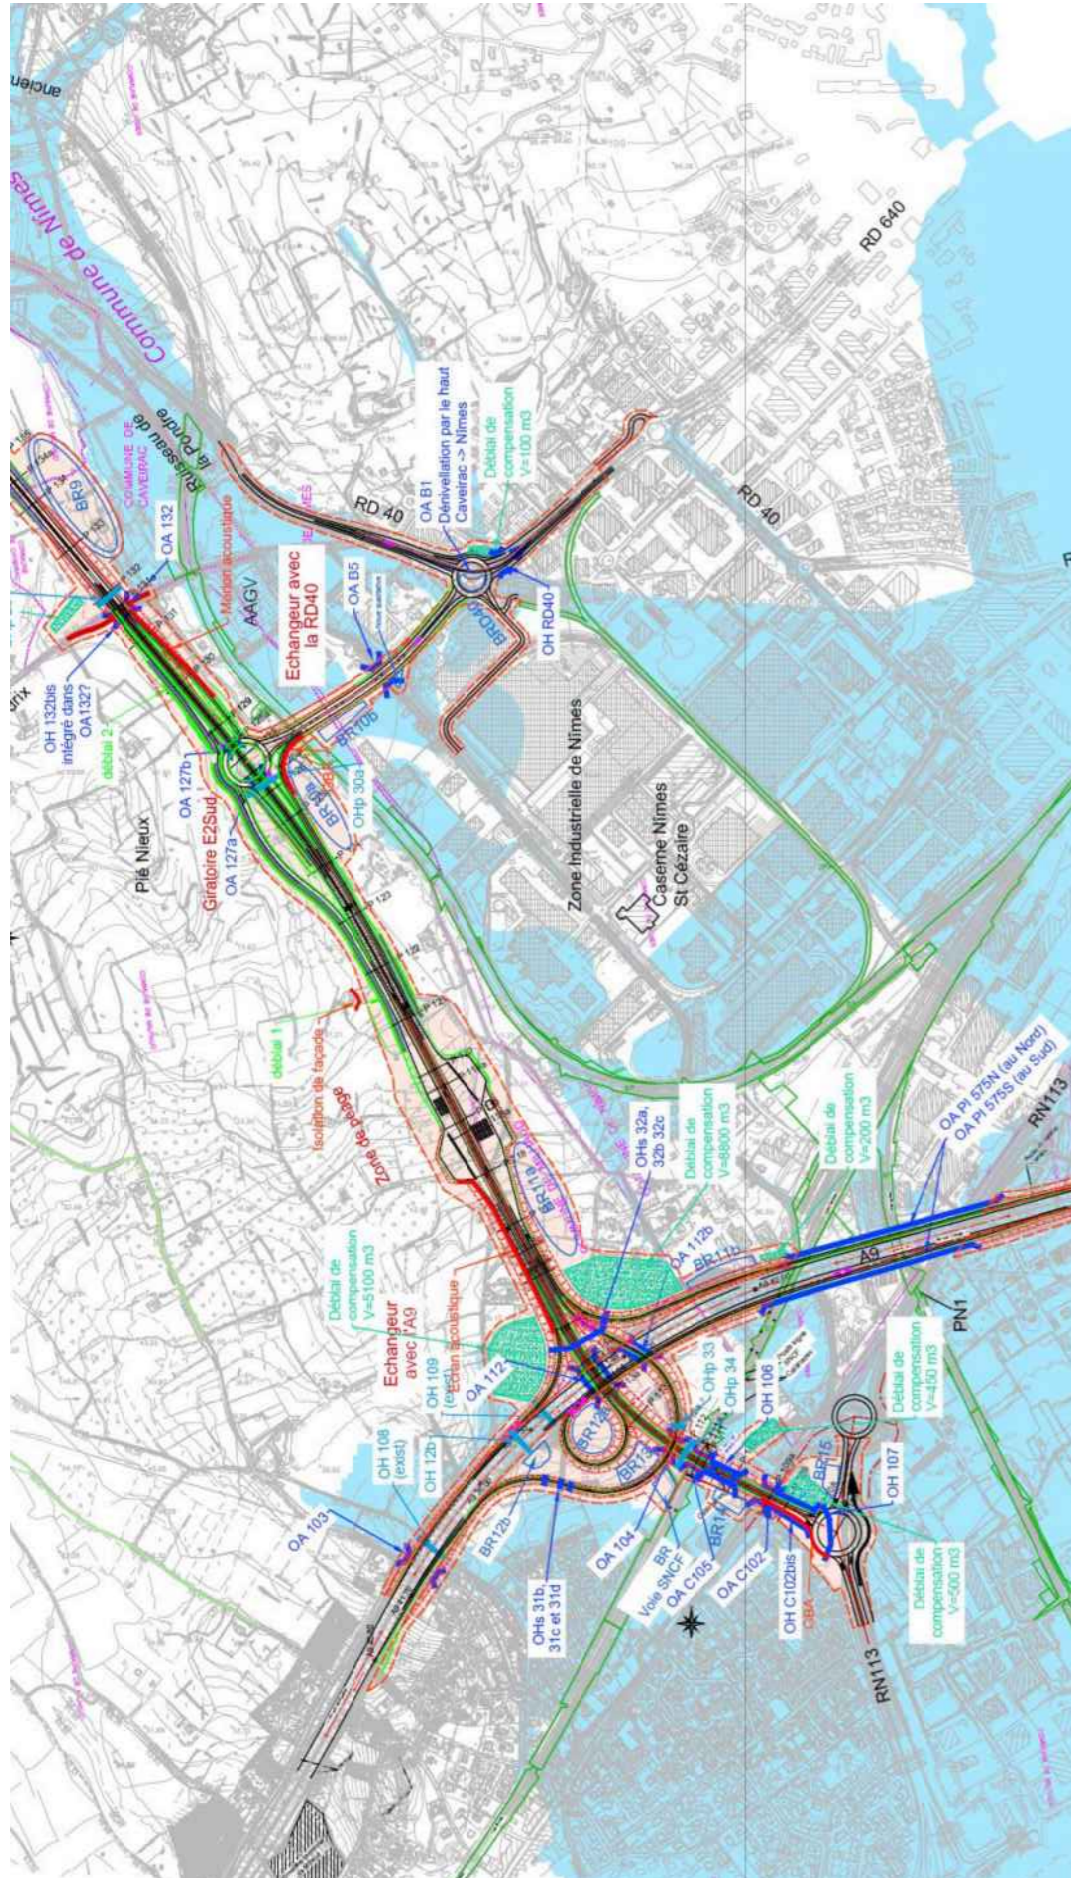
Plan de masse du projet – Secteur Sud, barreau et raccordement à l'A9 (Source : Présents, juin 2021)
